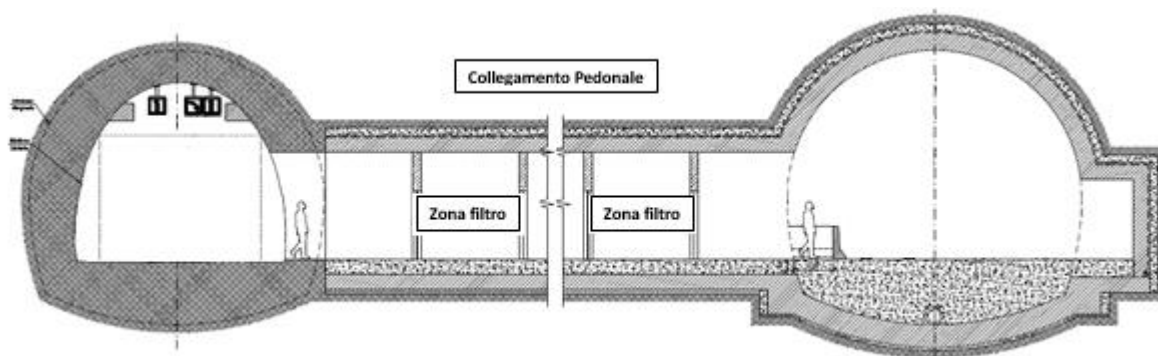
Schema di collegamento pedonale di sicurezza nel caso di galleria a doppia canna
